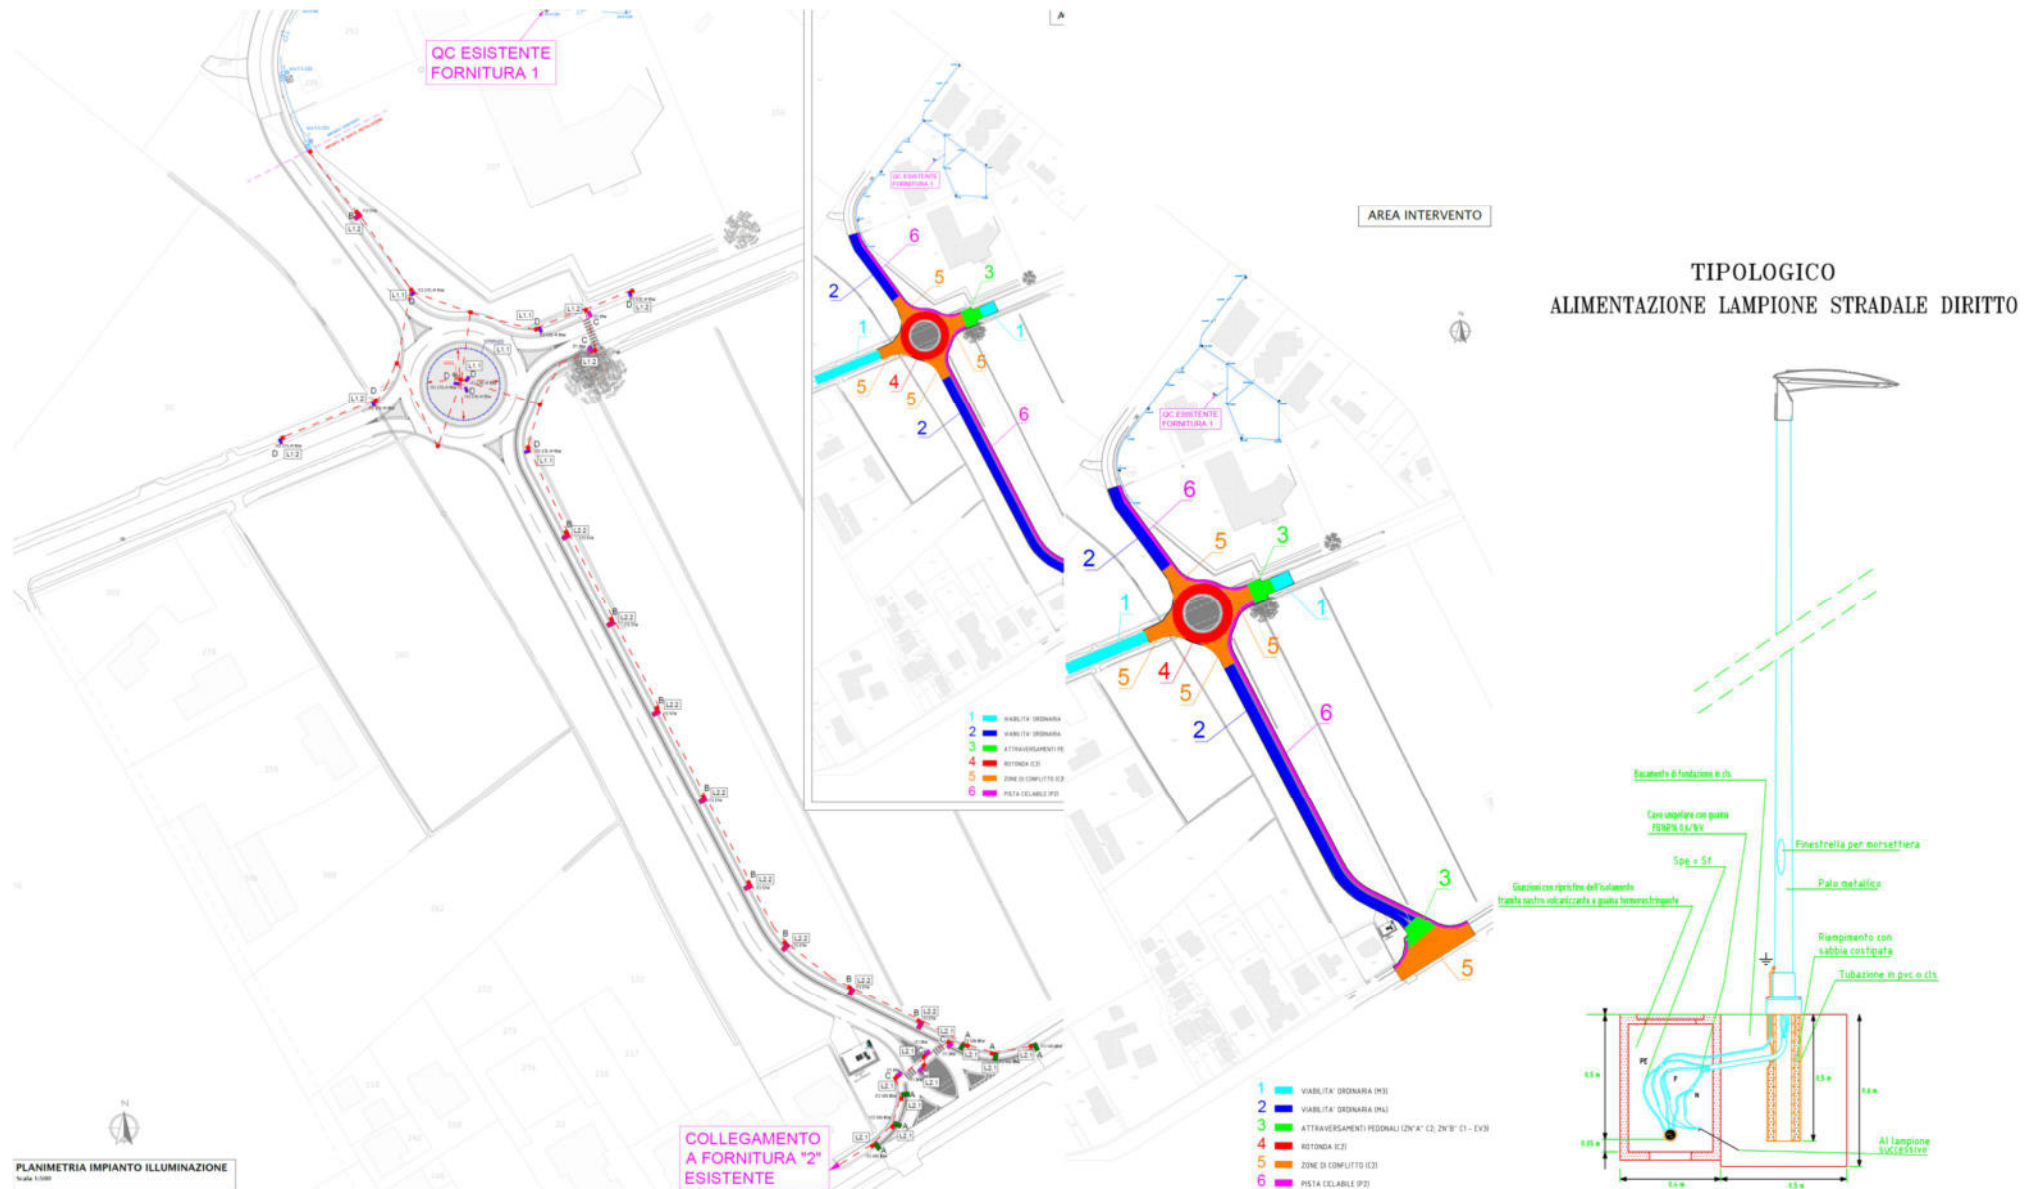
Estratto tavola E03 – IMPIANTI ELETTRICI Planimetria impianti elettrici Pubblica illuminazione
